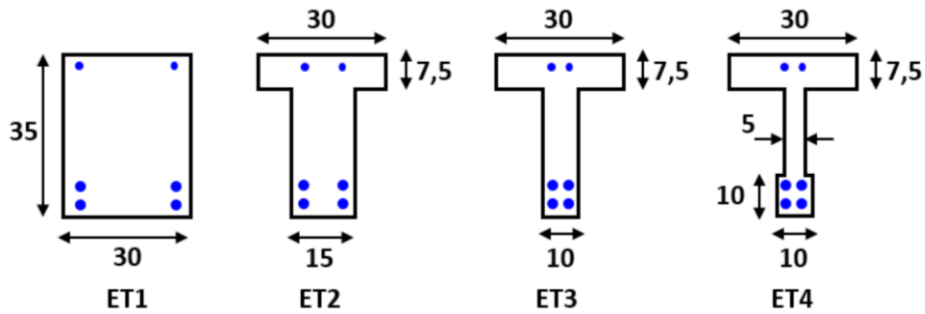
Seções transversais das vigas de Leonhardt e Walther (1962) (LAZZARI, 2016).
